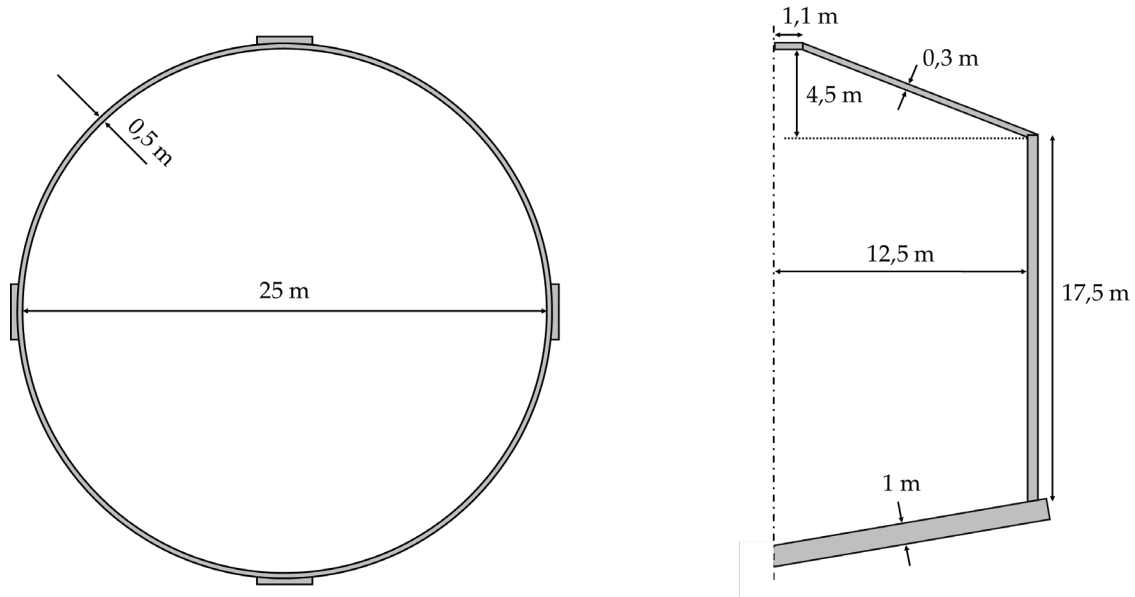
Esquema medidas digestor. Izquierda planta de la sección cilíndrica. Derecha corte vertical.
